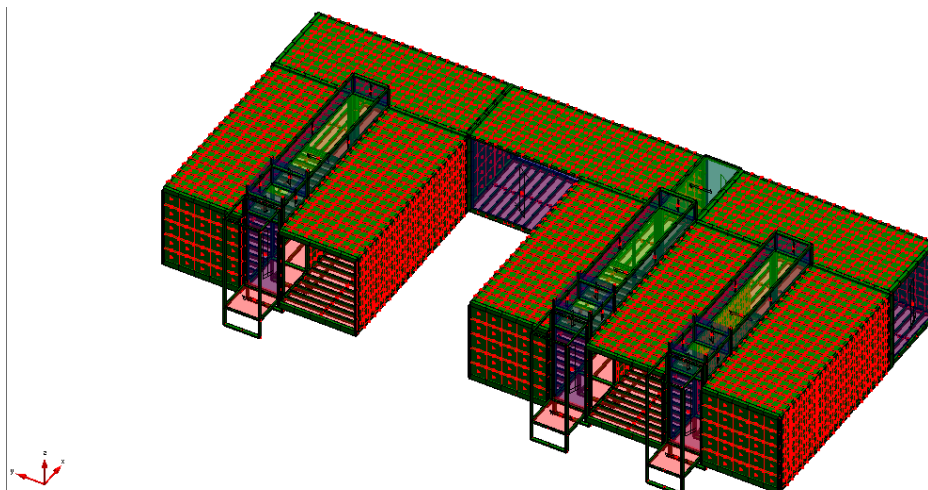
Vista solida del modello realizzato per la struttura in elevazione
